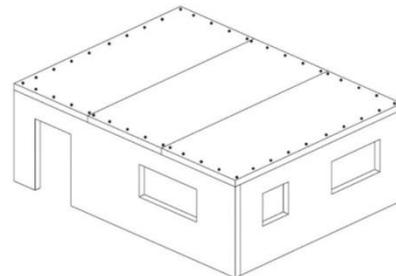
Diaphragme de plancher : Fixation en rive
